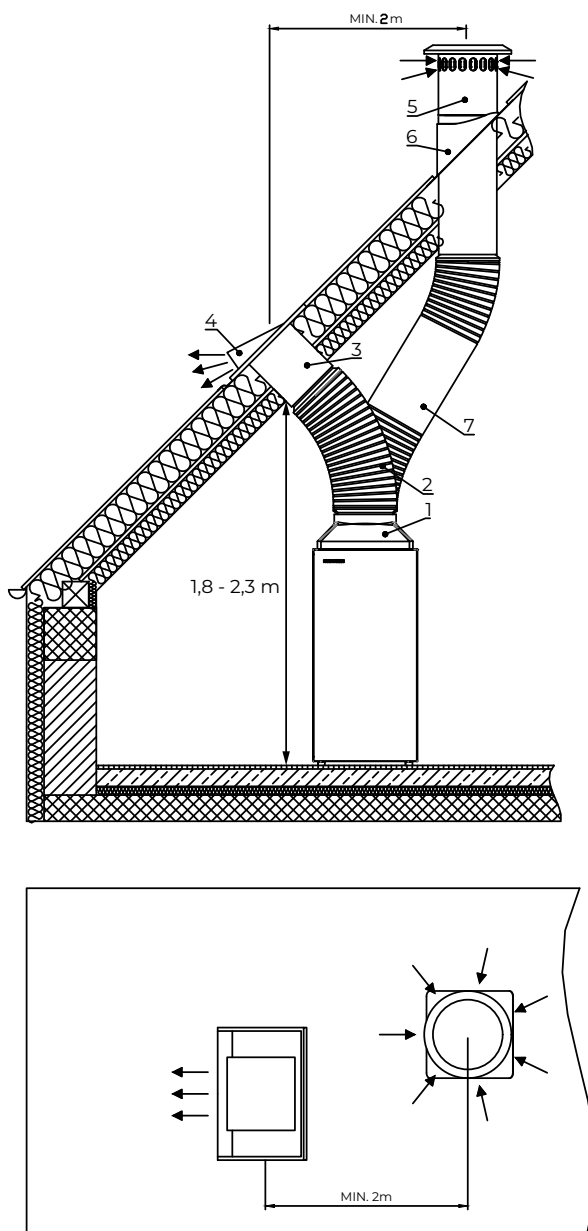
Bijlage 17_b - Plan voor het installeren van de geperforeerde kap
